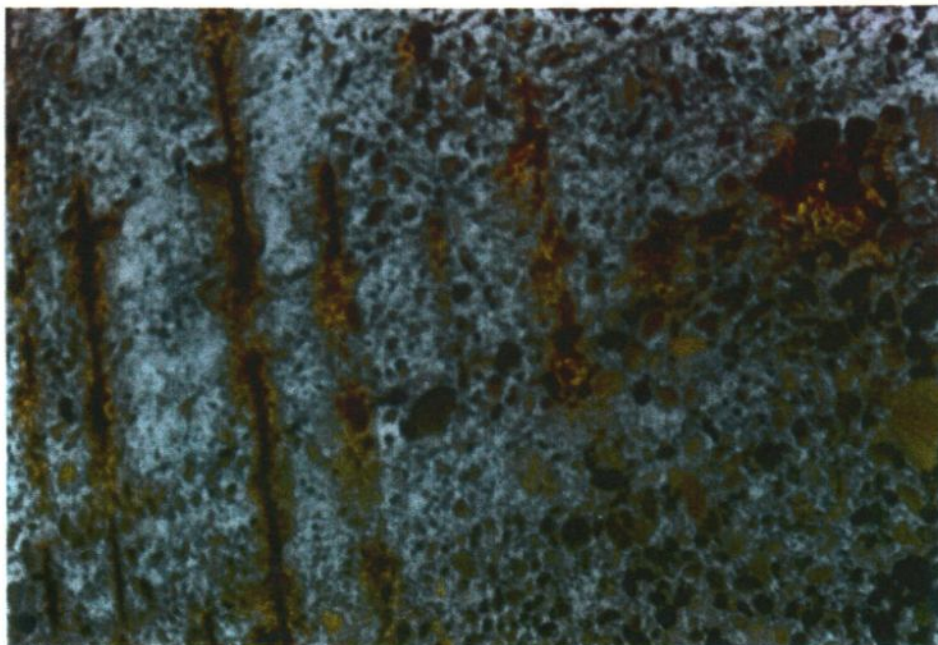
Degradarea betonului sub acțiunea ionului sulfat, prin cojirea succesivă a pietrei de ciment din beton
